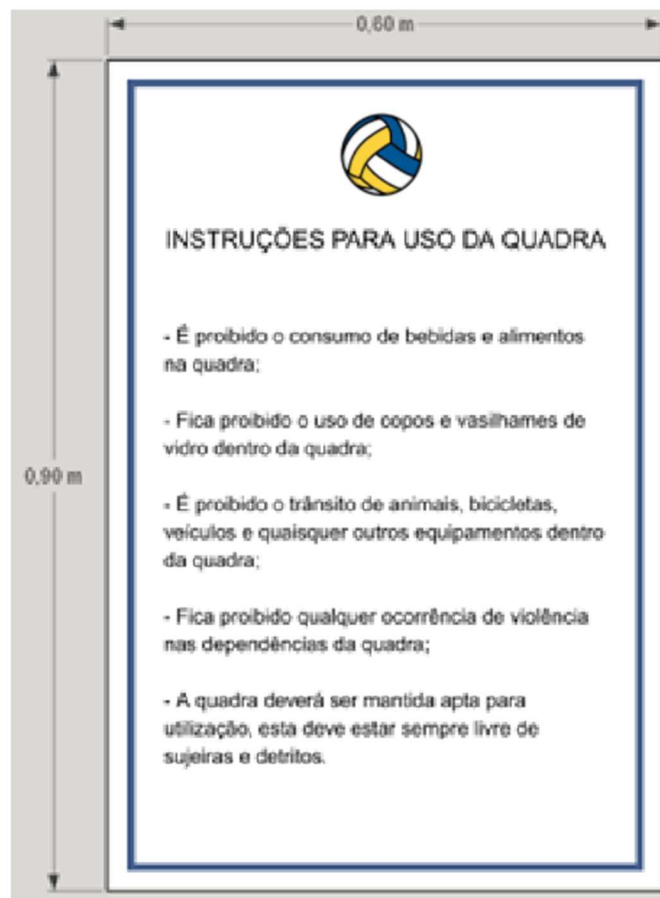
Detalhe Ilustrativo de placa de instruções (Fonte: Autor/2025)
